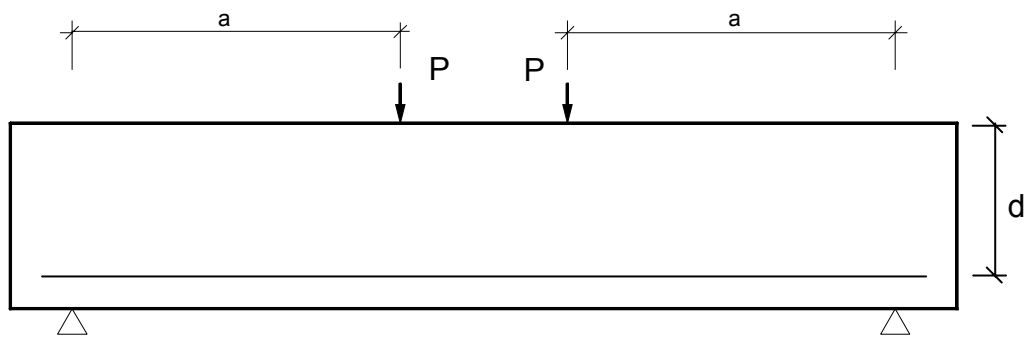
Stahlbetonbalken unter Last als Ausgangspunkt des Modells von Zararis/Papadakis
